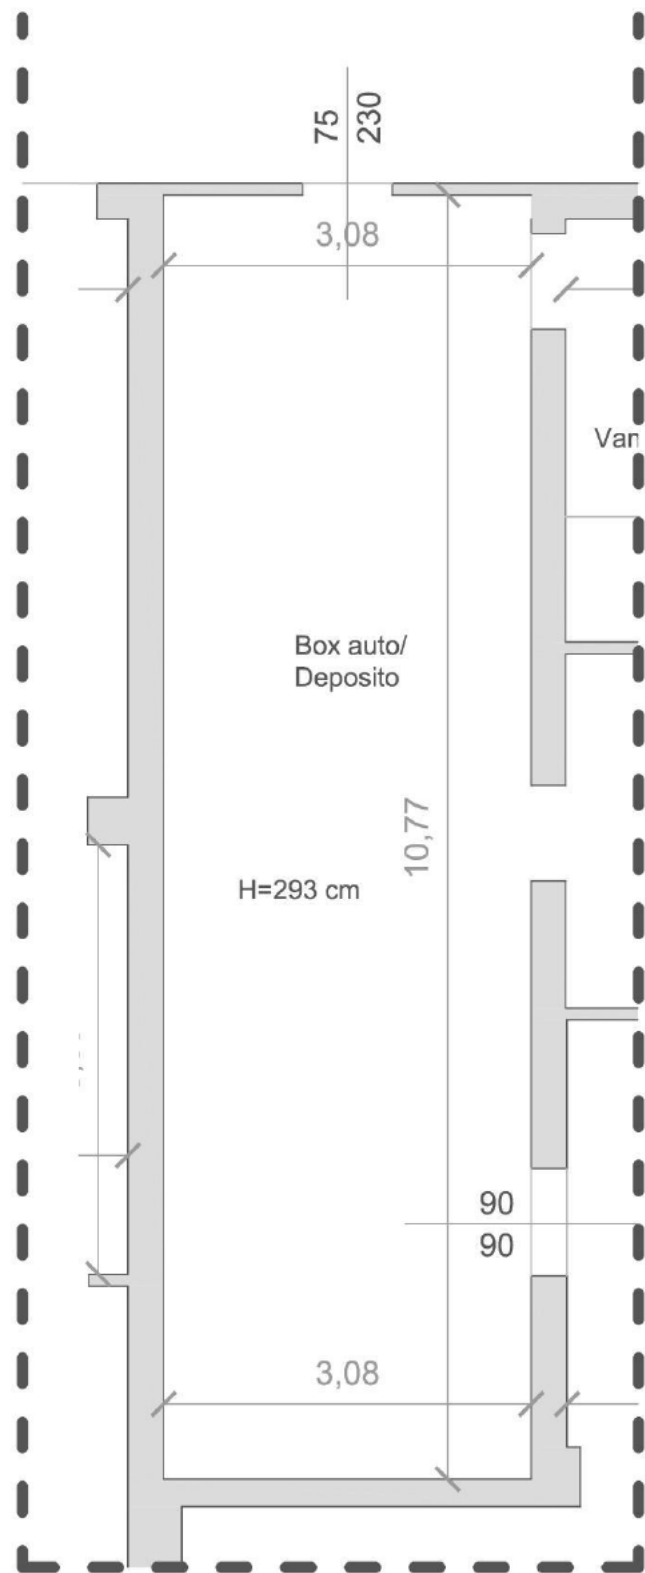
Subalterno 4 Pianta piano rialzato non in scala definita
